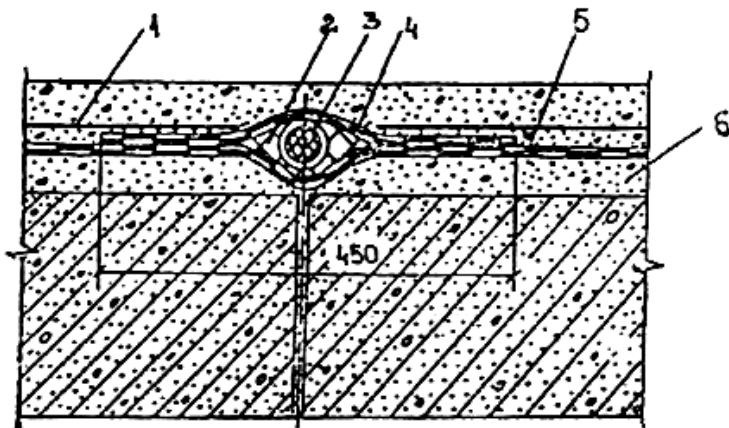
Конструкция гидроизоляции деформационного шва между прогонами:
